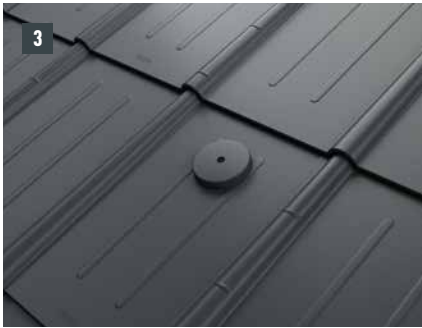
· Laufstegstütze auf einem Fußteil – Benötigtes Werkzeug
